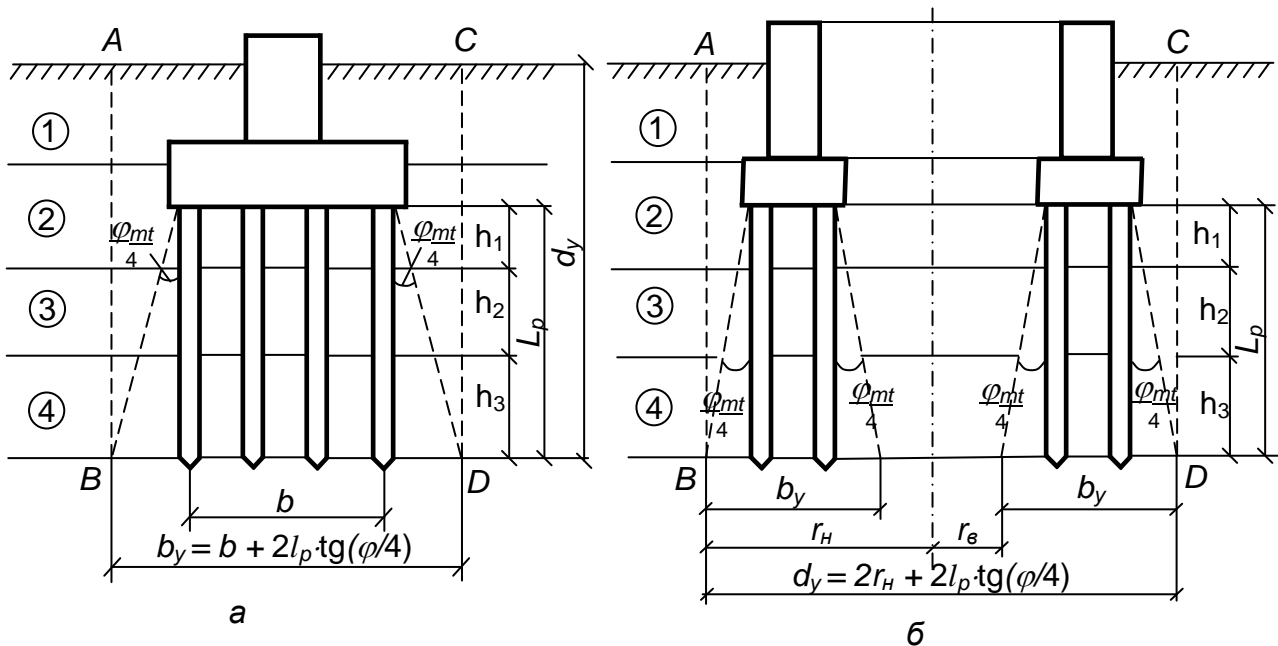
Схеми до розрахунку осідання пальового фундаменту:
